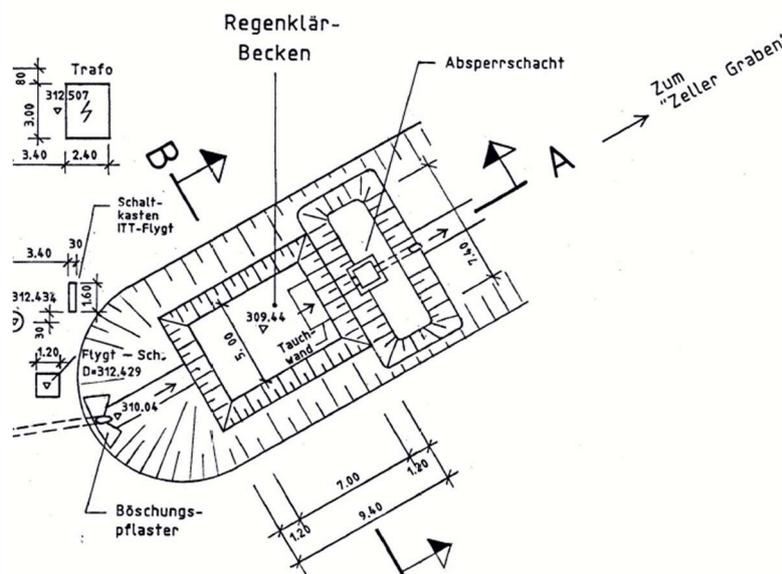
Alter Planungszustand des Regenklärbeckens in Rechteckformat mit Betonsohle
